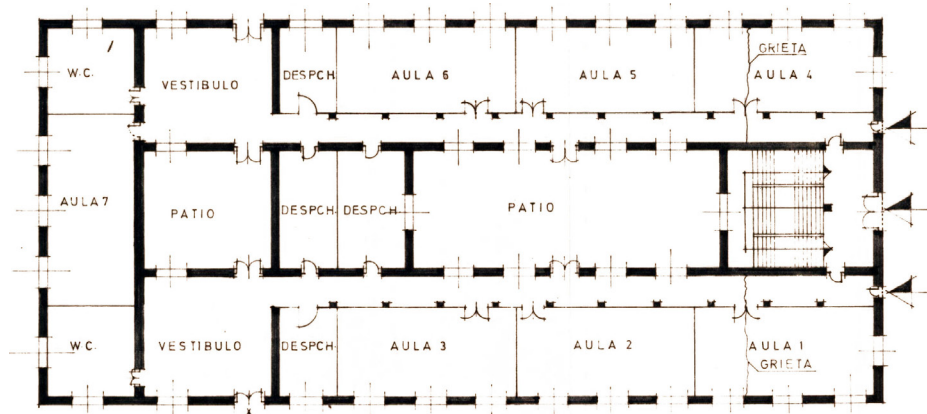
, Planta Baja. Proyecto 1970, Alejandro Vila Ruiz
